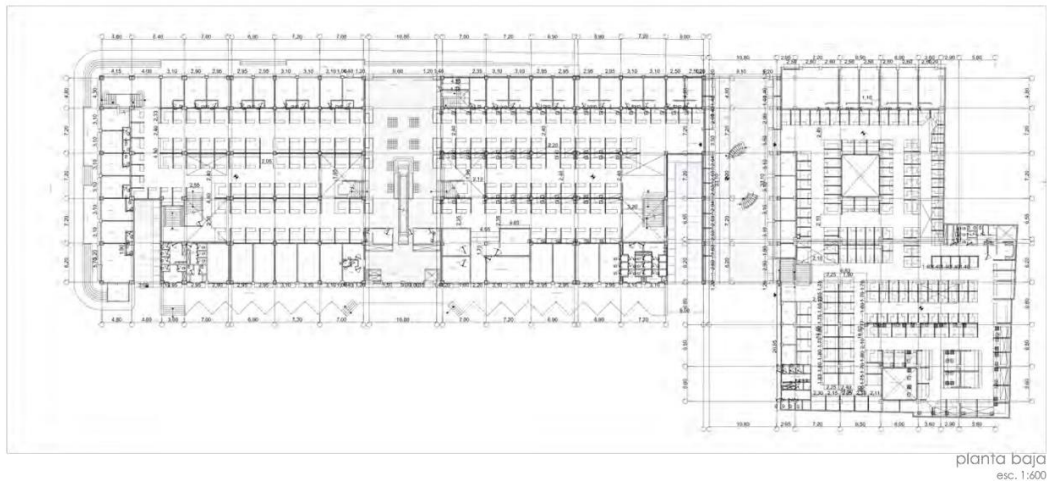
Estado actual planta baja. (Bustamante, 2018).
